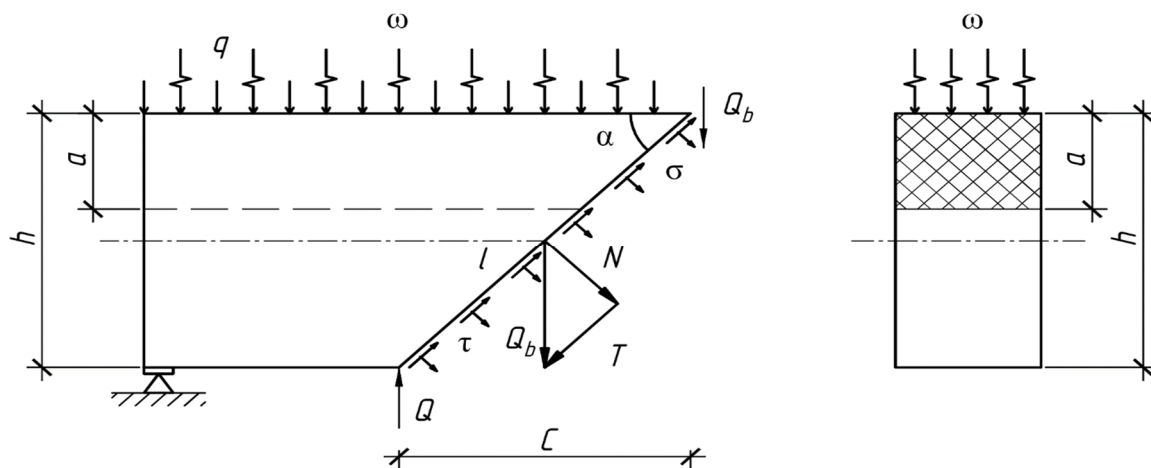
Схема усилий в сечении, наклонном к продольной оси железобетонного элемента с прямоугольной формой поперечного сечения
